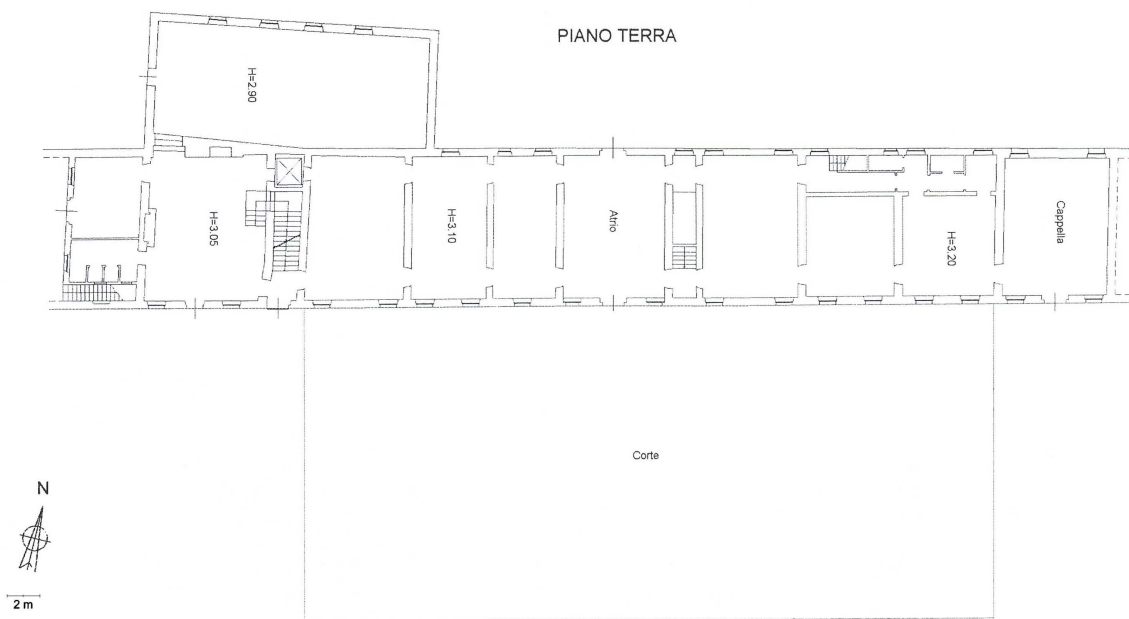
Corpo padronale: pianta piano terreno. Stato attuale
